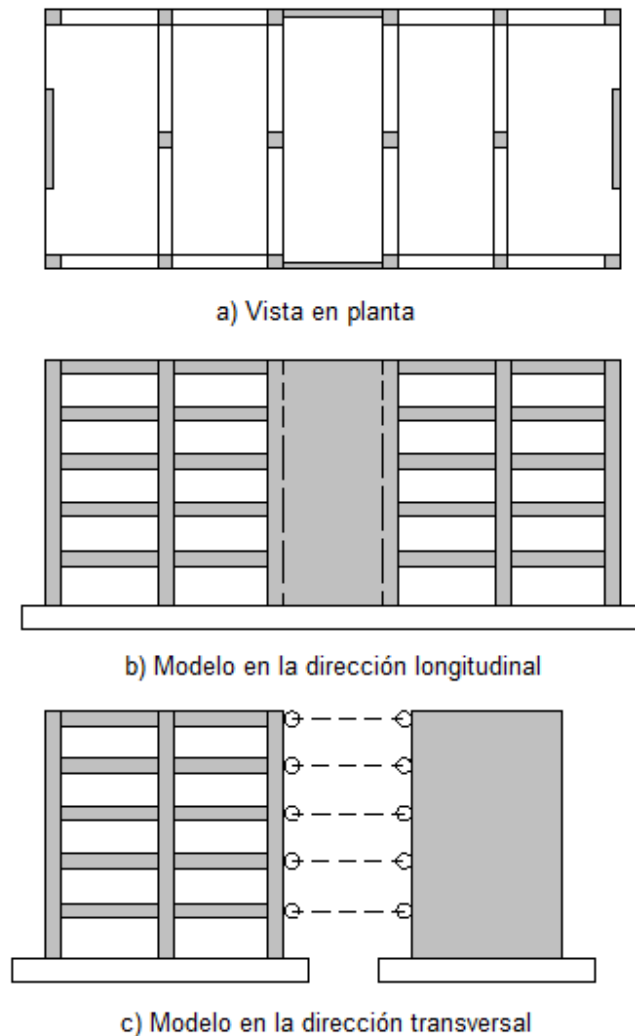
7. Sistema estructural Muros - Pórticos (Adaptado de Priestley et al. 2007)
